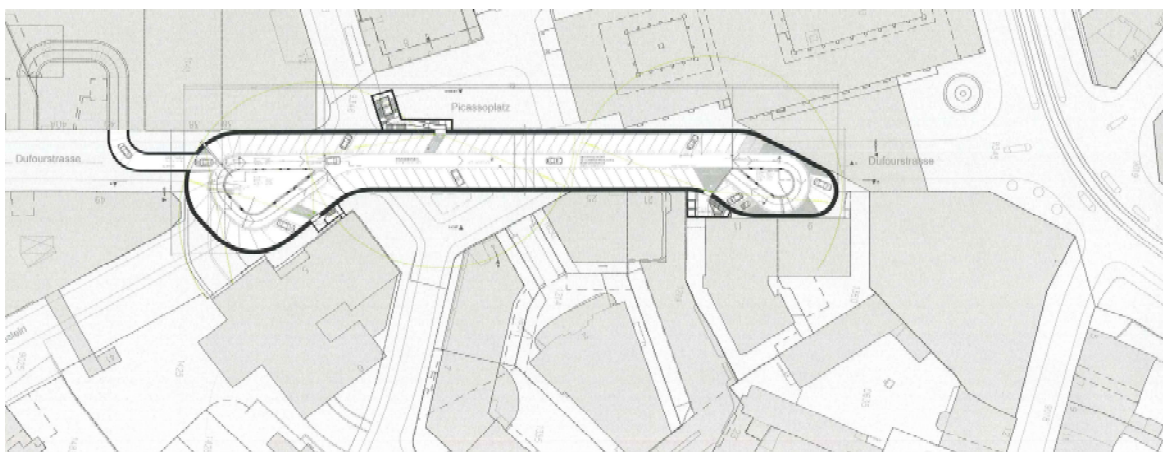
Parking «Picasso», Grundriss, Stand Planung 2010
